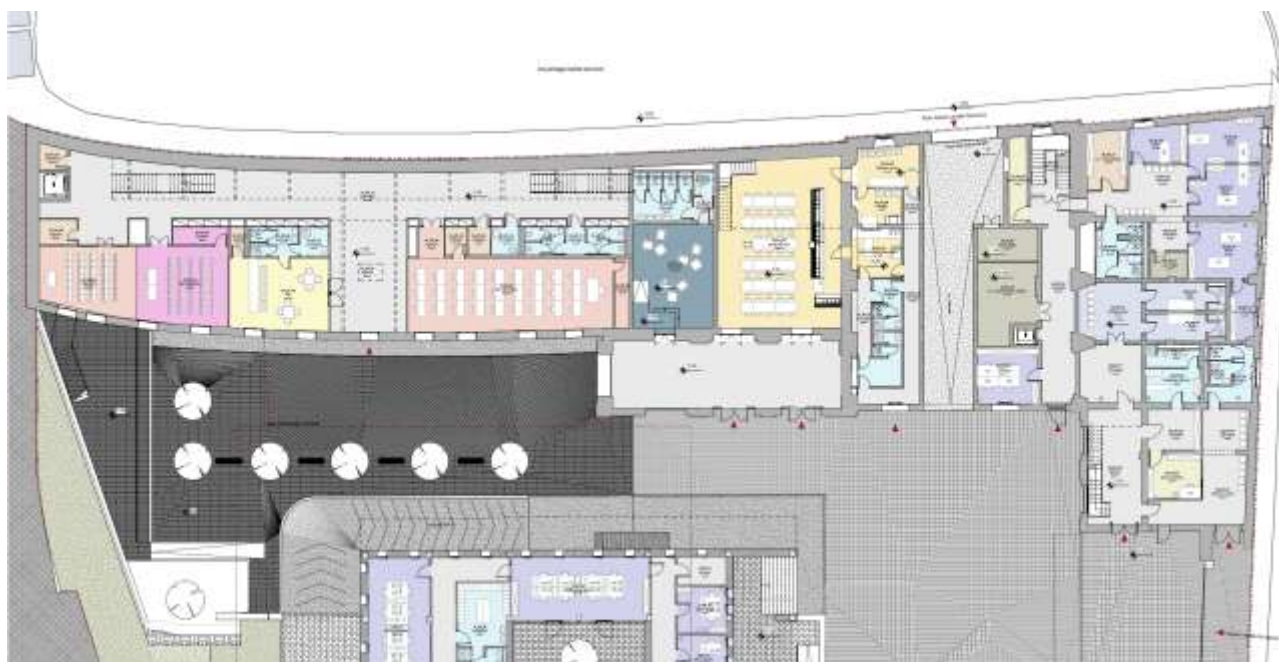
pianta piano terra – estratto della pianta con le indicazioni funzionali
